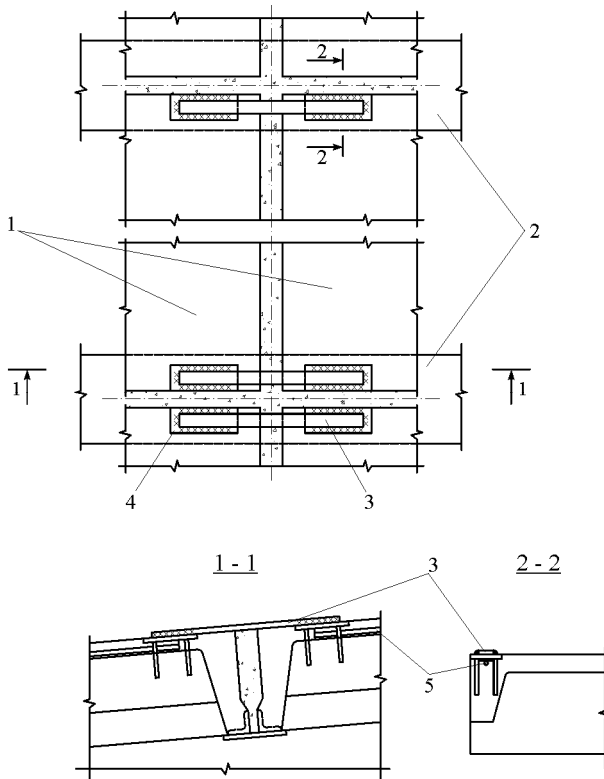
Соединение плит покрытия между собой стальными накладками:
